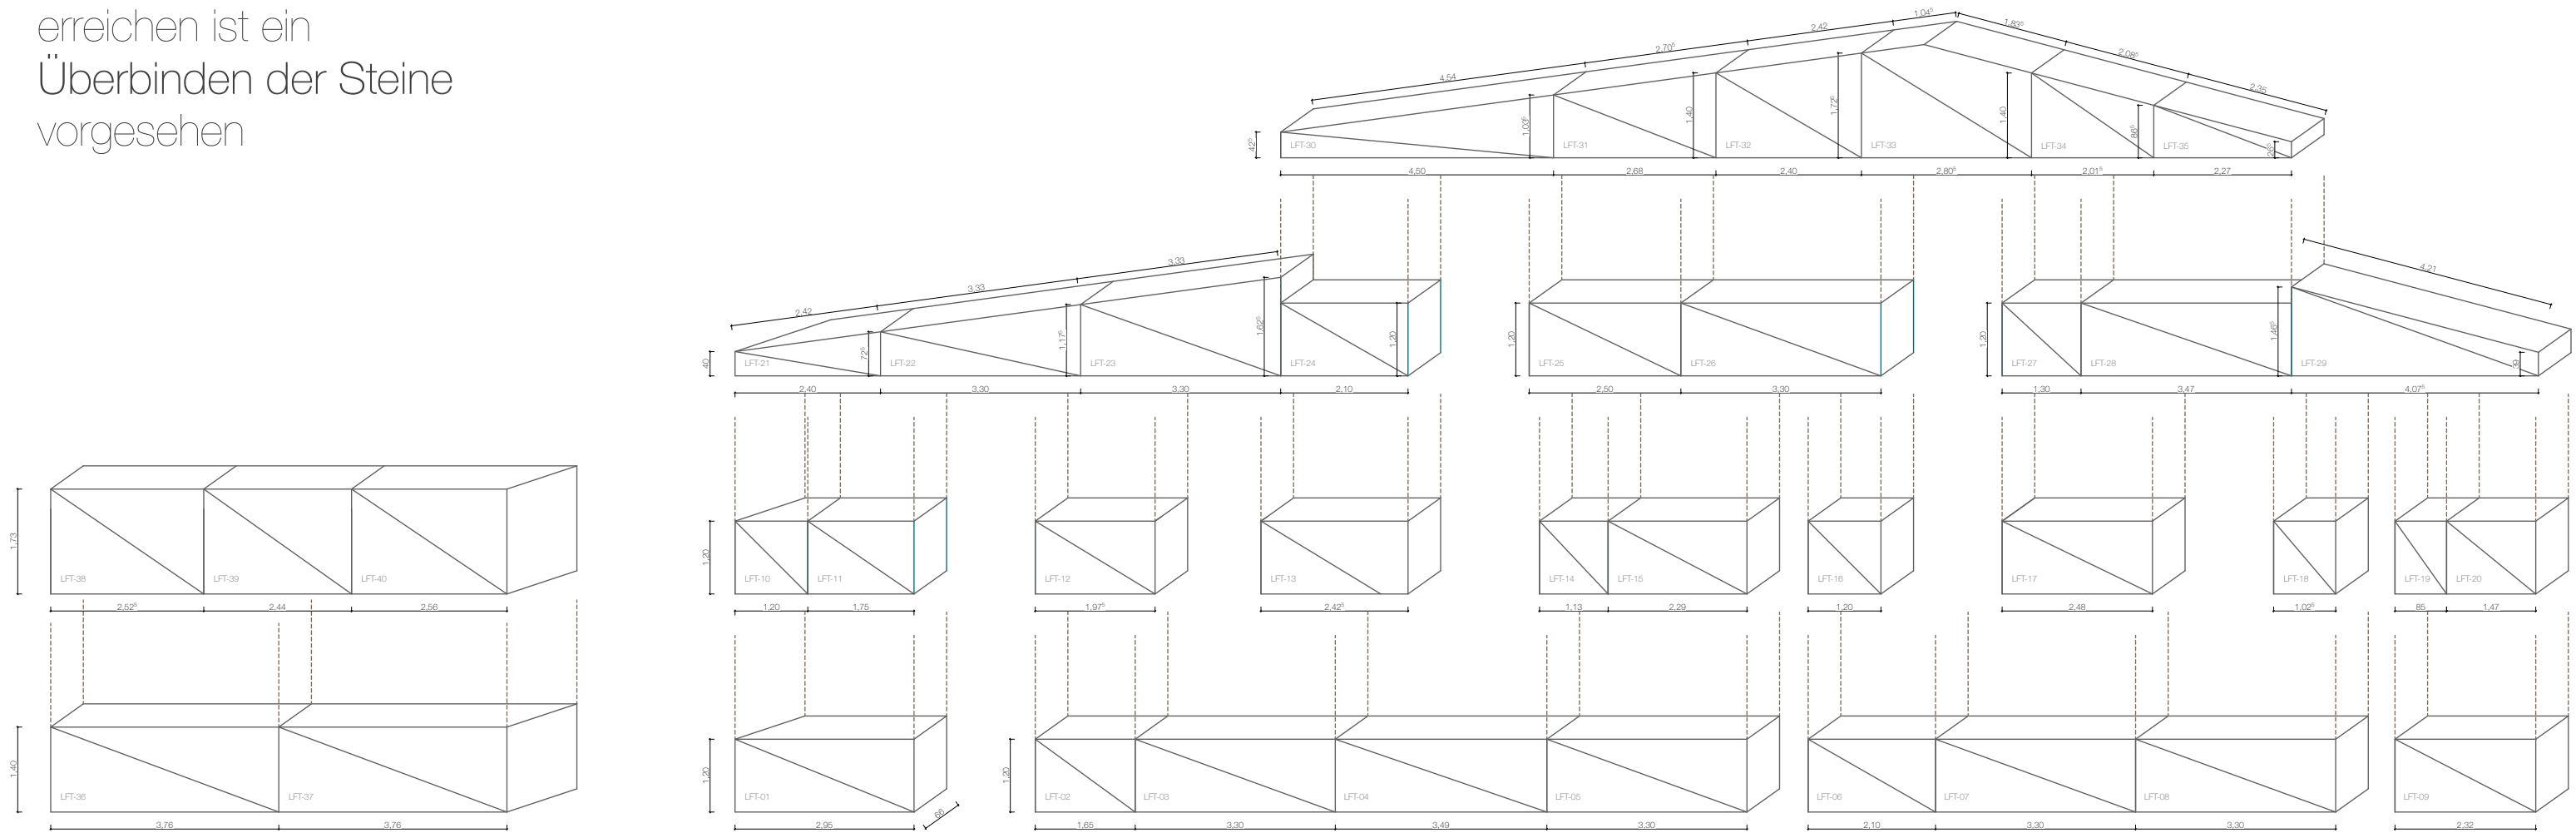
Elementierung Beispiel-Fassade Gruppenhaus
